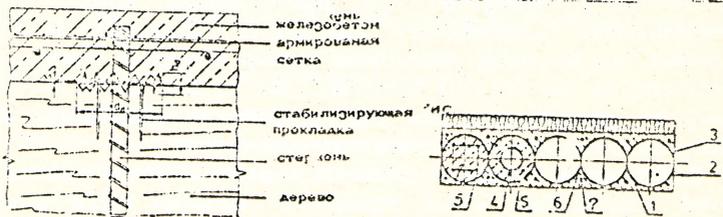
Соединение стержня с арматурой. Рис.3. Элементы перекрытия.
